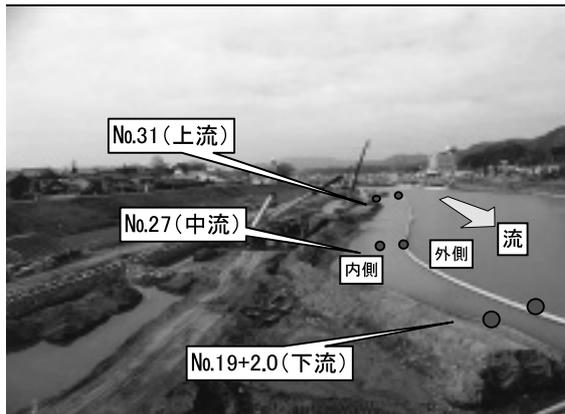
水質測定位置と汚濁防止フェンスの設置状況
